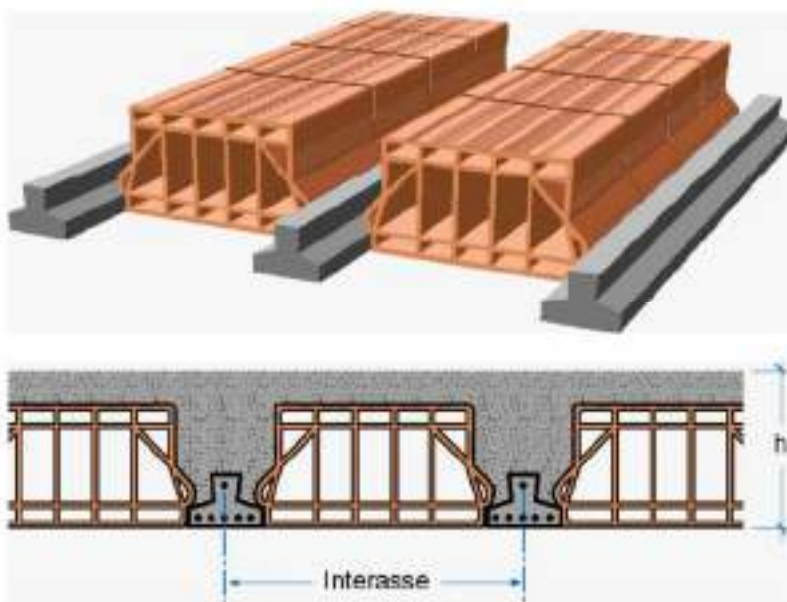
Esempio di solaio in cemento armato a travetti in cemento armato e blocchi interposti⁶
